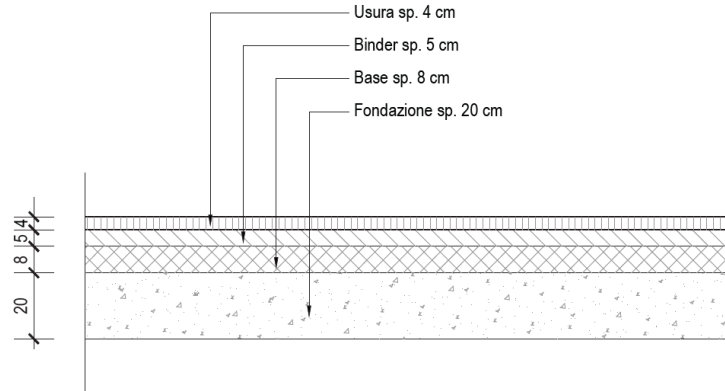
Dettaglio pacchetto di pavimentazione NV04
